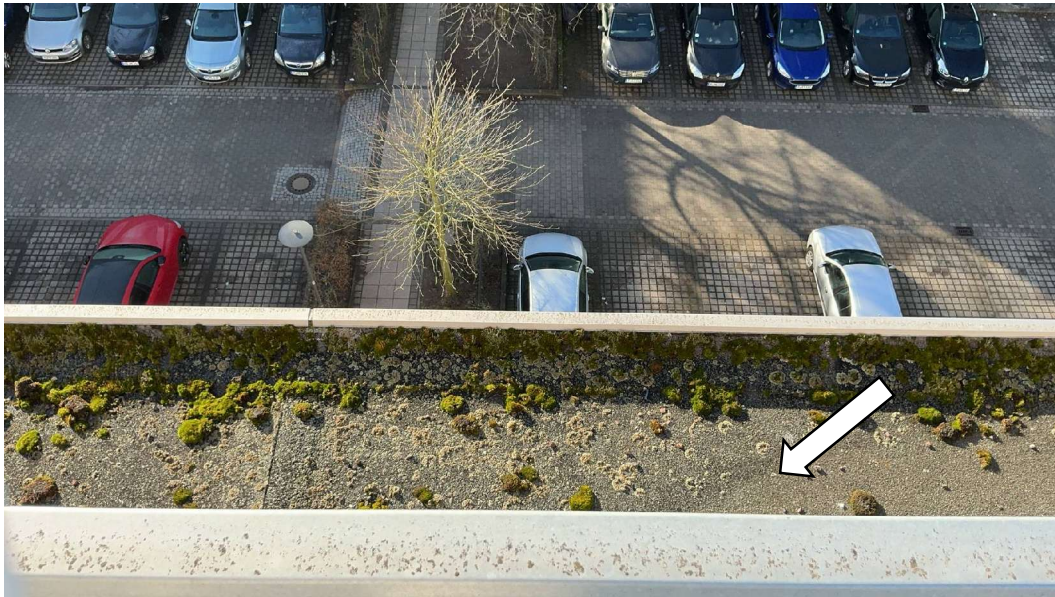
Ohne Asbest-/ KMF-/PAK - Befund: Abdichtungsbahn auf Balkondach (Zugang nicht möglich),
